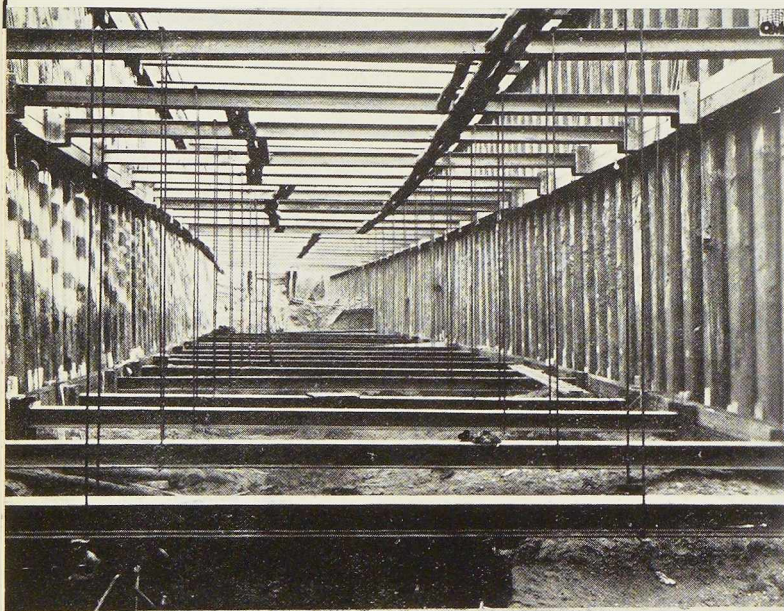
Construction de murs-digues sur le Canal Albert à Haccourt. Battage de 4.135 tonnes de palplanches Ougrée n° III en acier au cuivre, inclinées de 10° sur la verticale, de 8^m25 de longueur.
